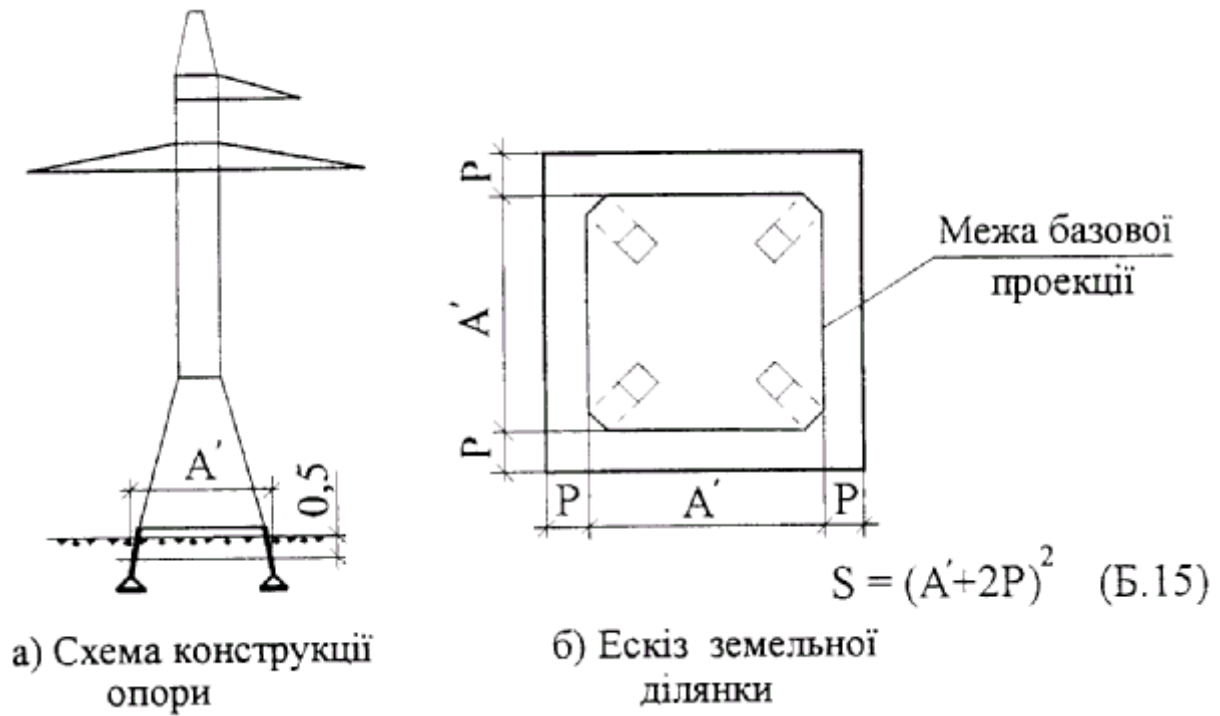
Баштова опора на фундаментах з вертикальними стояками
